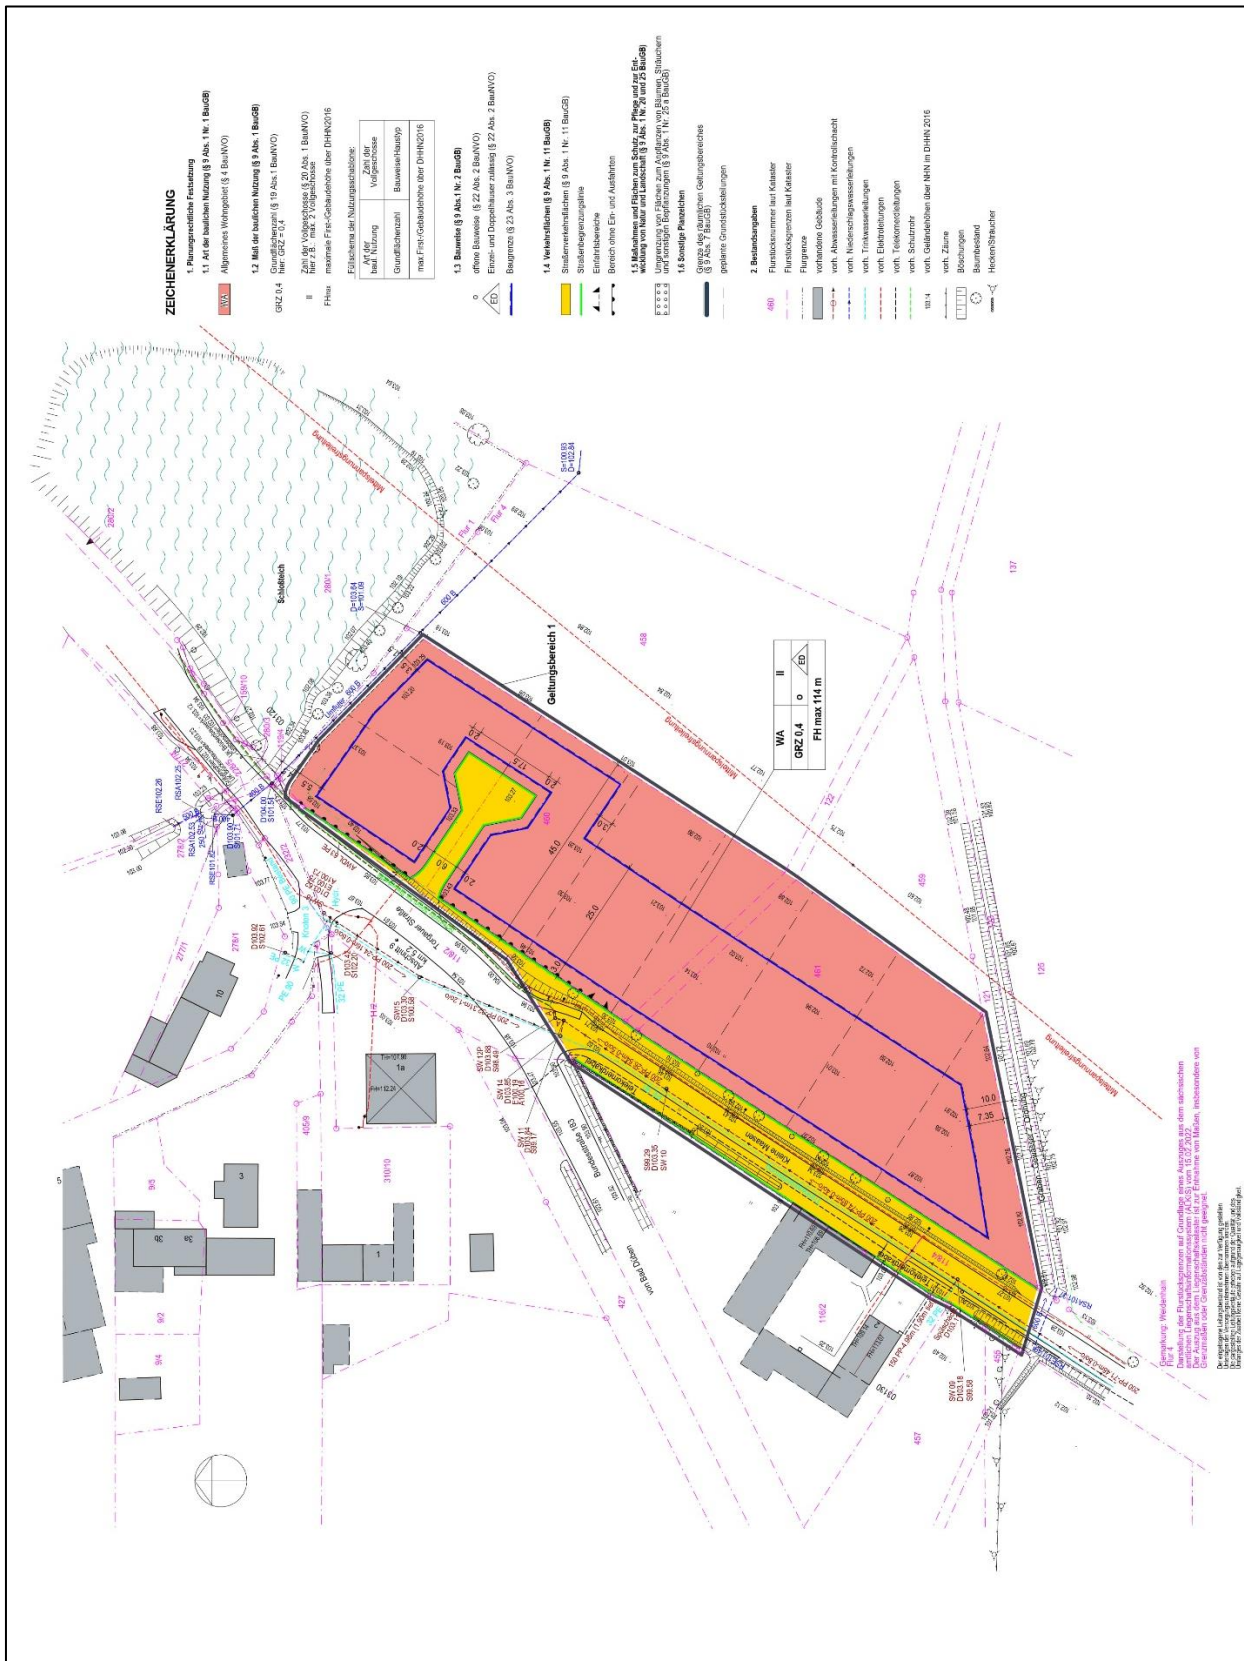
geänderter Entwurf Bebauungsplan „Wohnbebauung Kleine Maasen, Weidenhain“; Stand 10.04.2024 (ohne Maßstab)
